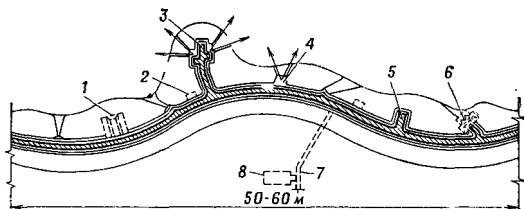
Оборудованный участок траншеи на позиции отделения: 1 — перекрытая щель; 2 — ниша; 3 — вынесенная ячейка с площадками для пулемёта; 4 — запасная площадка для пулемёта; 5 — вынесенный окоп для противотанкового гранатомёта; 6 — перекрытая бойница и козырёк над вынесенной ячейкой; 7 — ход сообщения; 8 — убежище.
